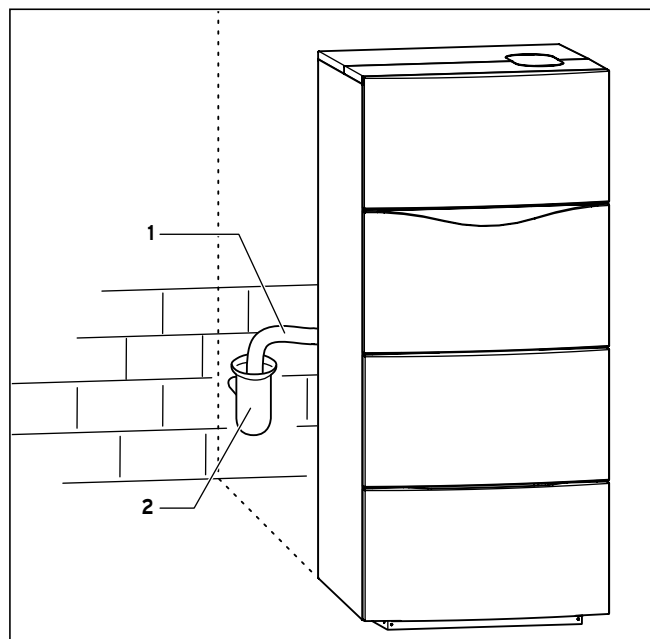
Монтаж сливного трубопровода конденсационной воды
